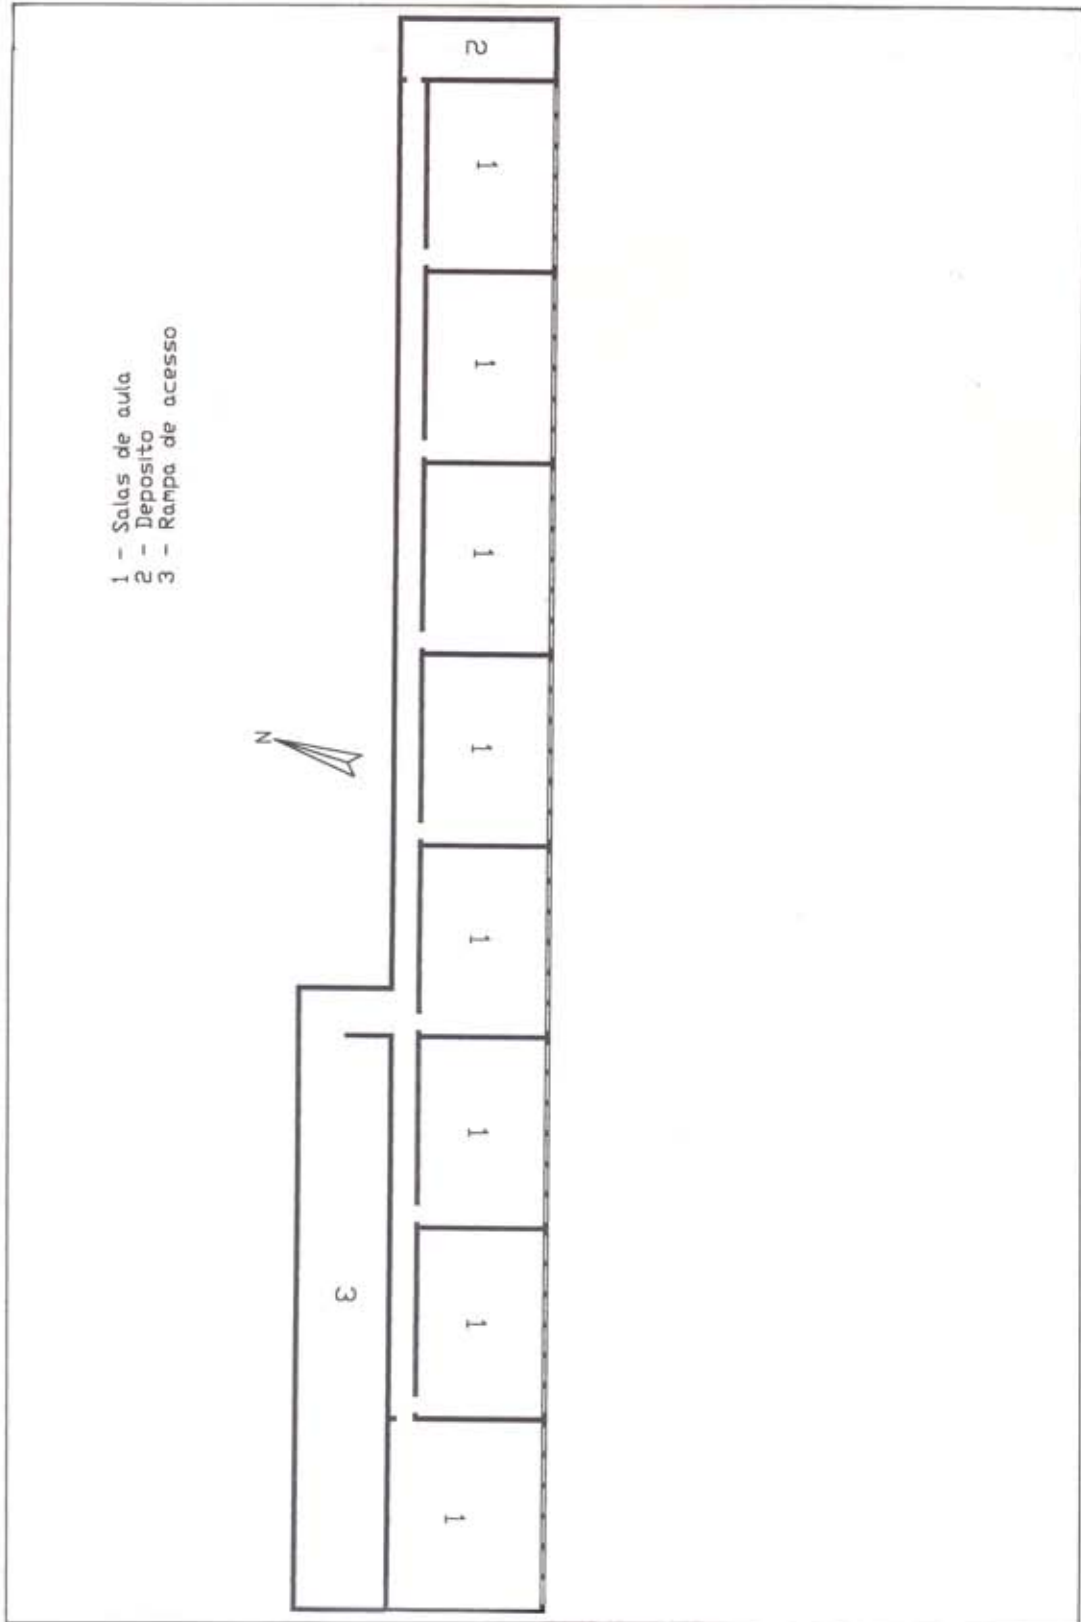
Planta baixa esquemática - disposição das salas de aula (2º pavimento)
